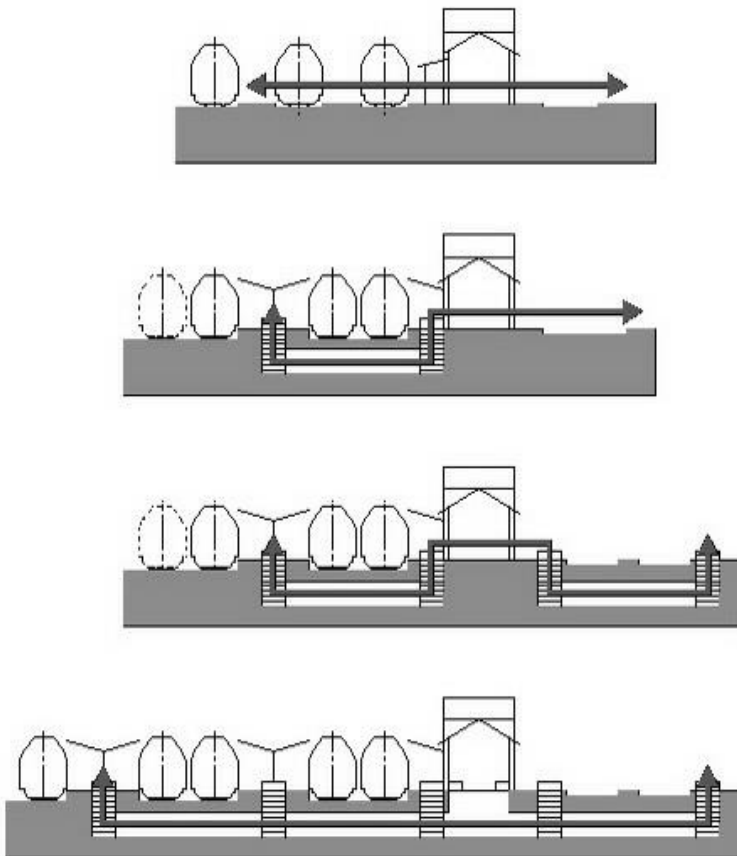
Dispoziční a provozní schéma terminálu typu „transit center“
